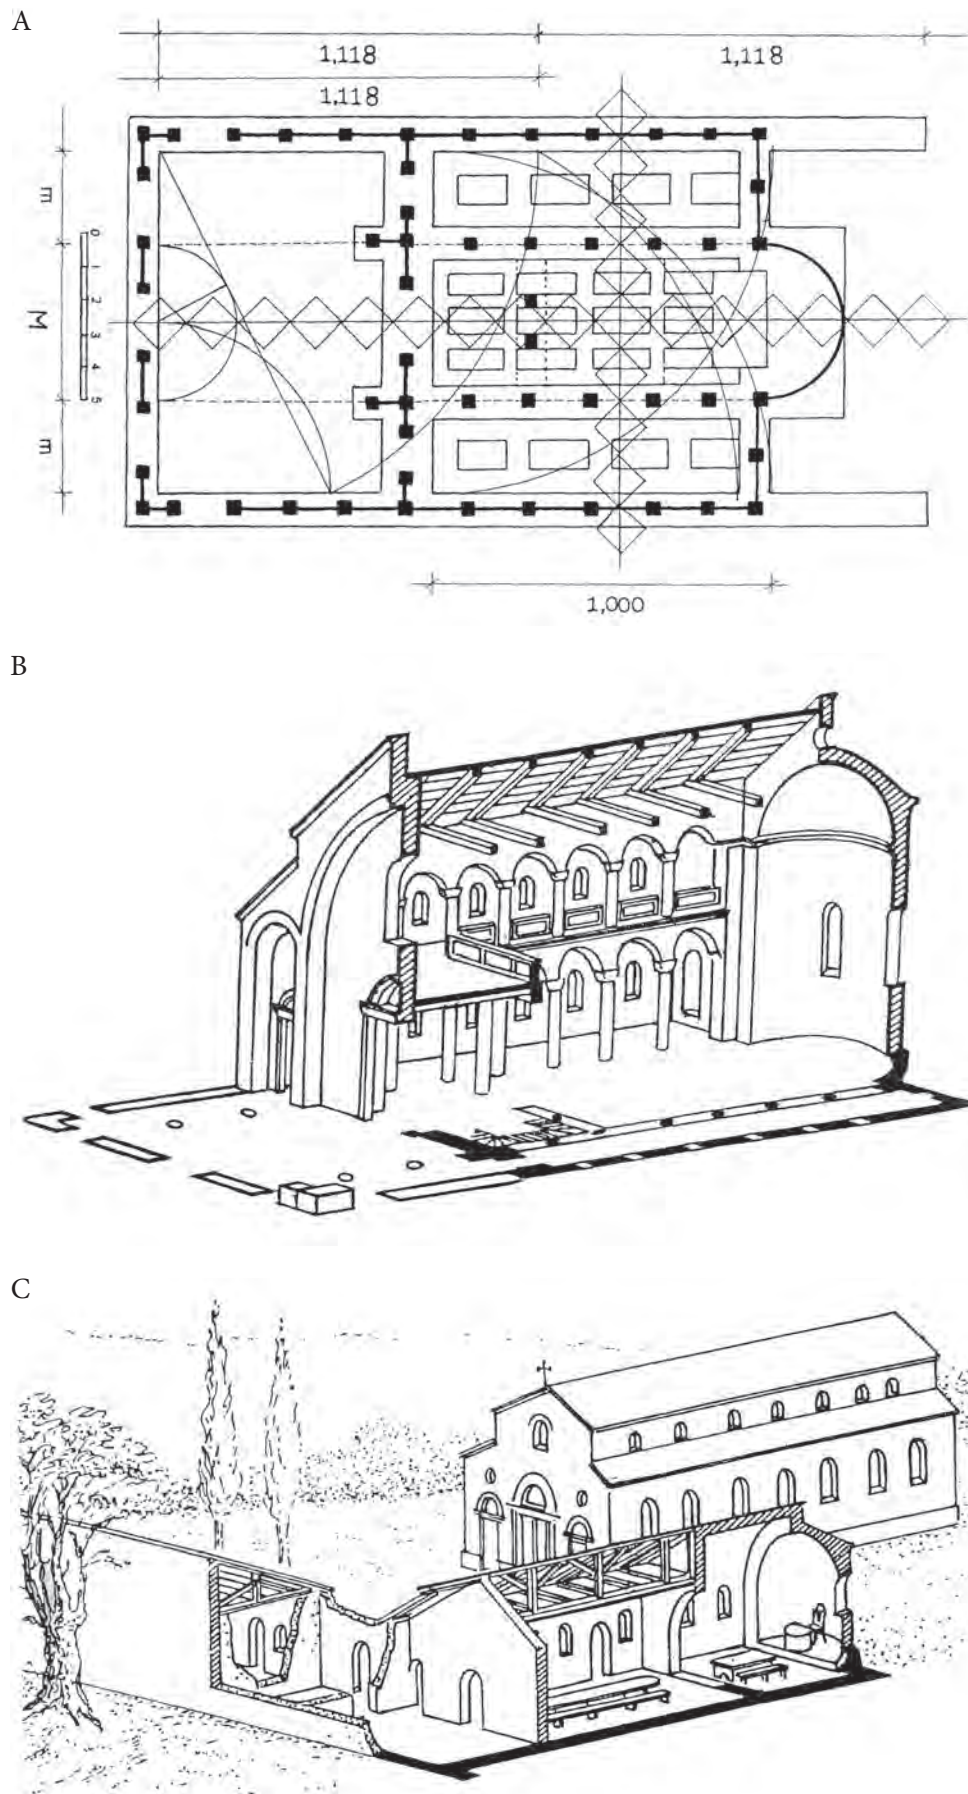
Die Kirche in Čerešeto, Preslav. A – Grundriss, B – Längsschnitt und C – Kloster - perspektivische Darstellung (A – Dončeva; B, C – S. Bojadžiev).
